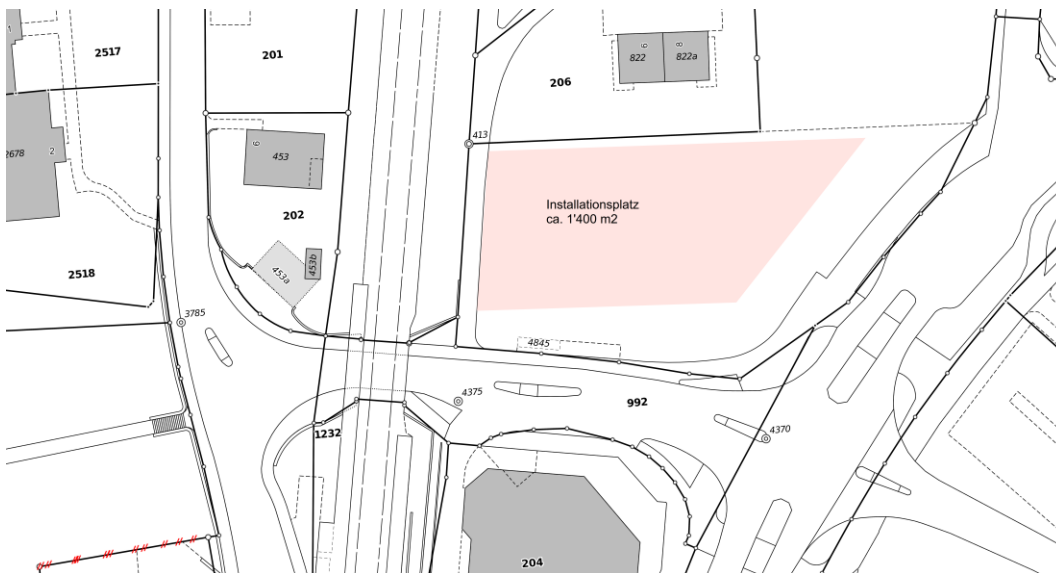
Ausschnitt Grundbuch mit Installationsplatz (schematisch dargestellt)
